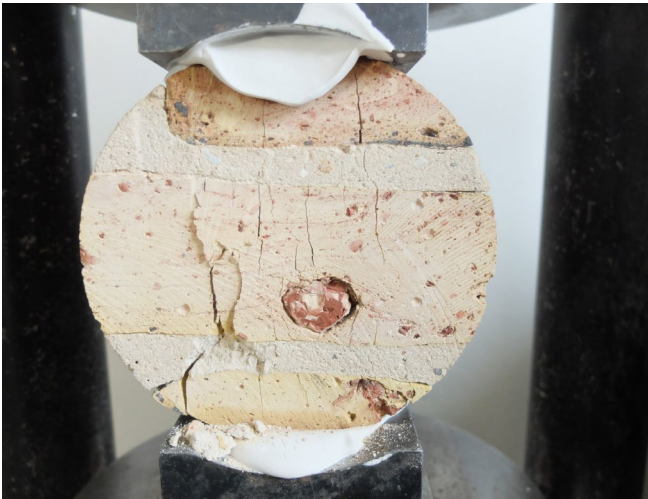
Prüfkörper nach der Prüfung mit typischem Rissbild
